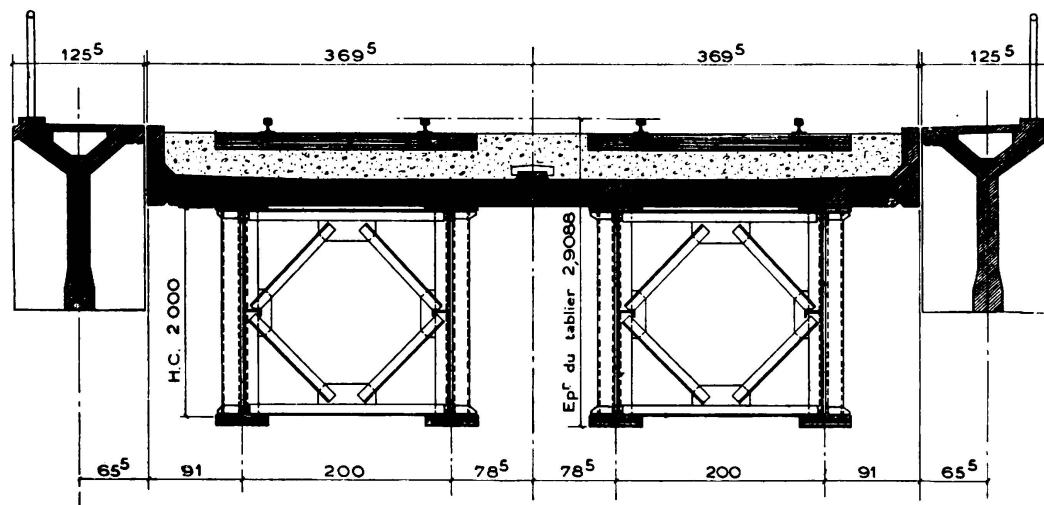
Pont de BOUZONVILLE. Coupe transversale
